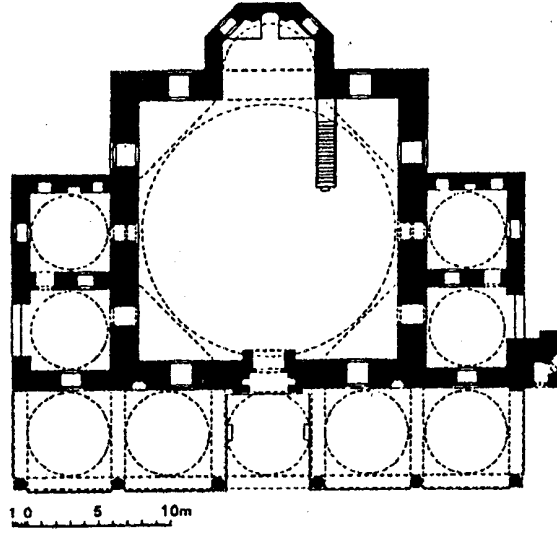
مسقط أفقي للجامع الأزرق في تبريز (عن Pope)
